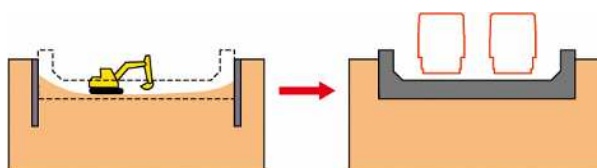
擁壁（開削工法）の施工概要（イメージ図）
